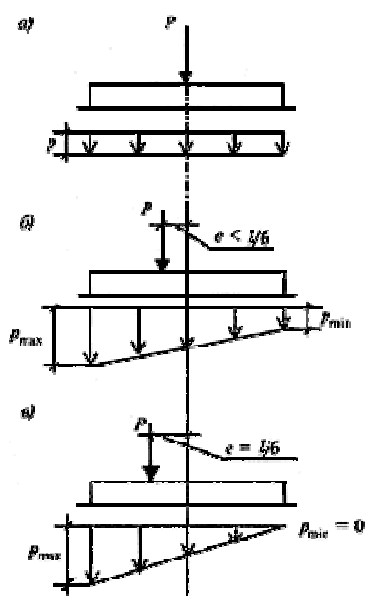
Эпюры давлений по подошве фундаментов при центральной и внецентренной нагрузках без отрыва от грунтового основания:
